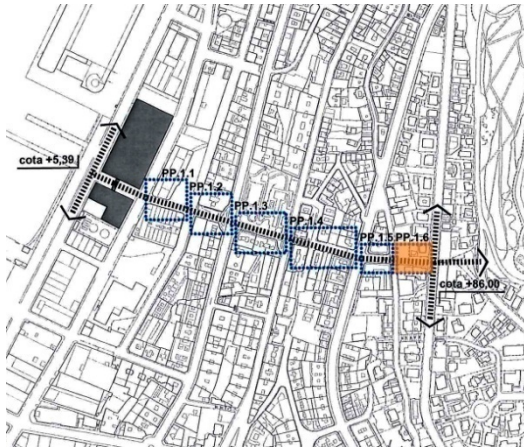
Tramo del proyecto Vigo Vertical empleado en el trazado de la red estructural.
